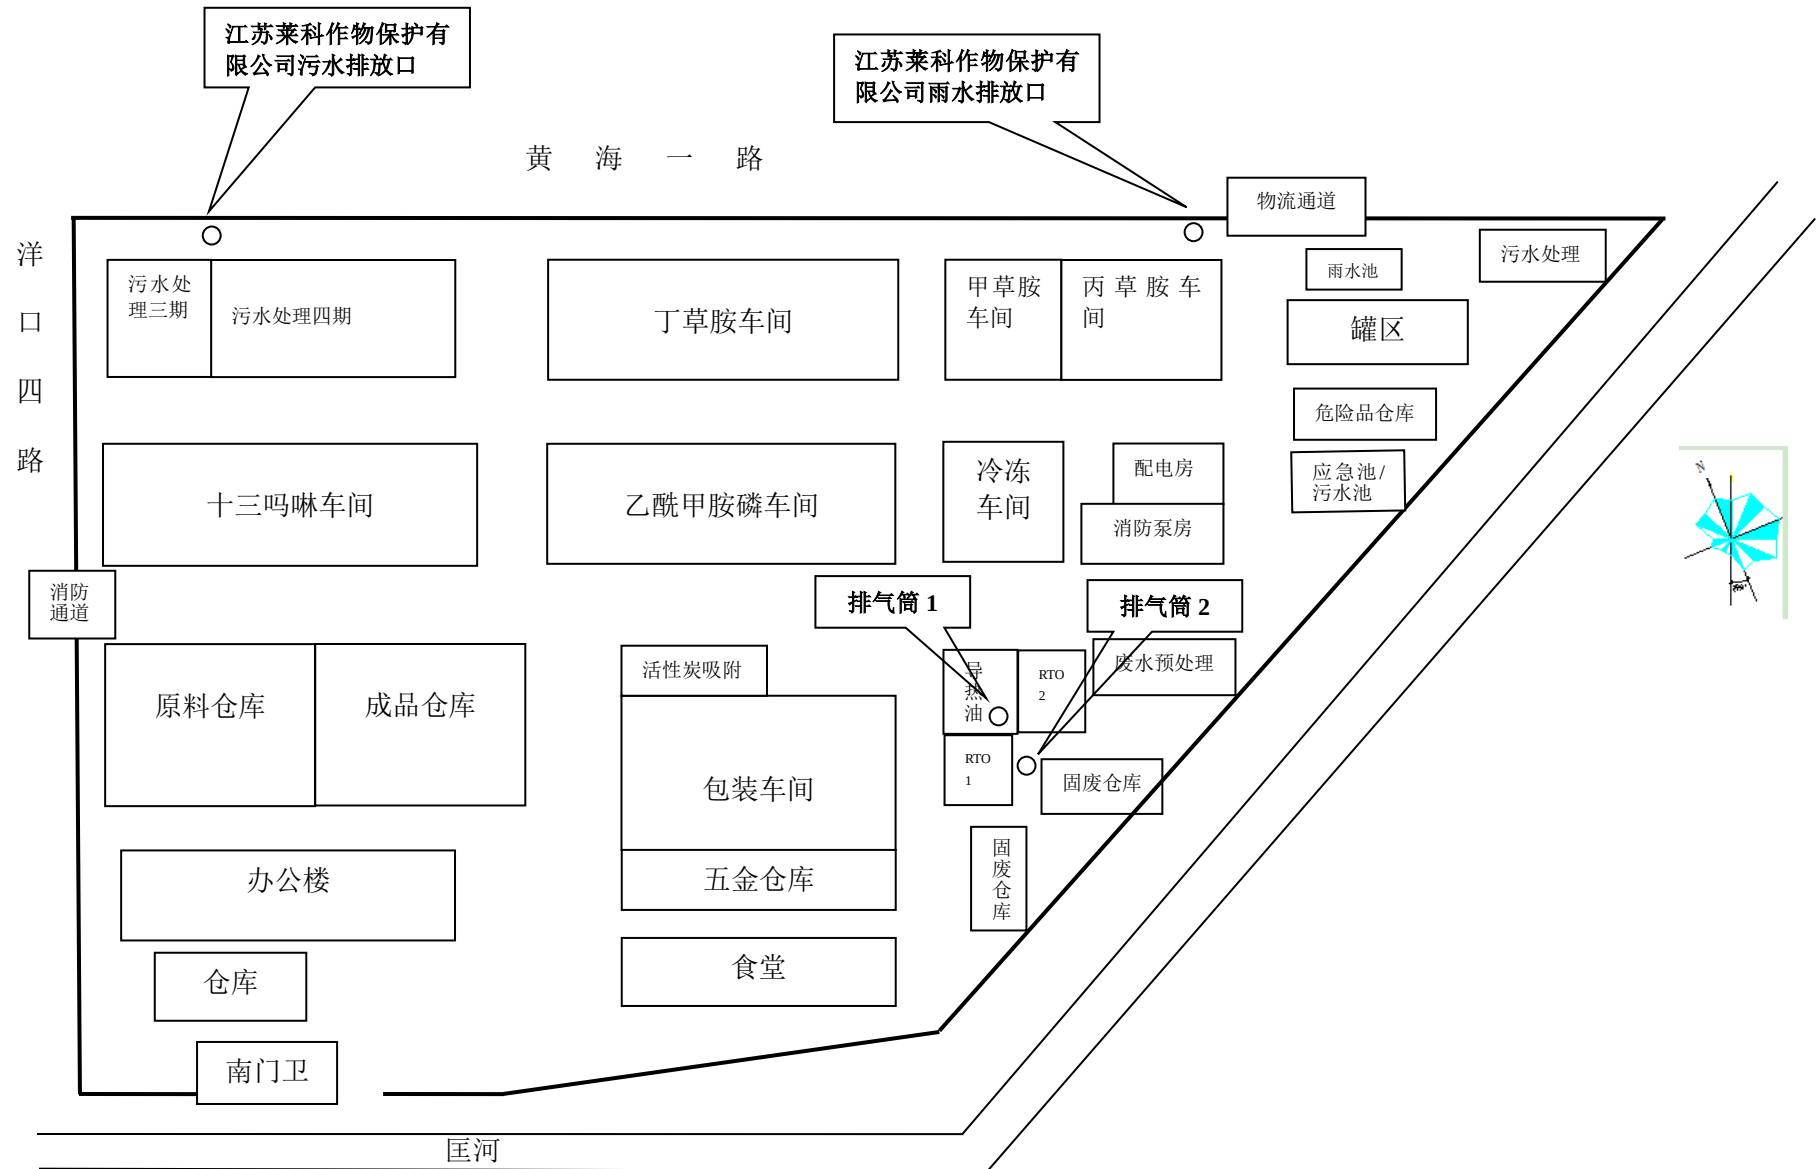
江苏莱科作物保护有限公司厂区平面布置图
